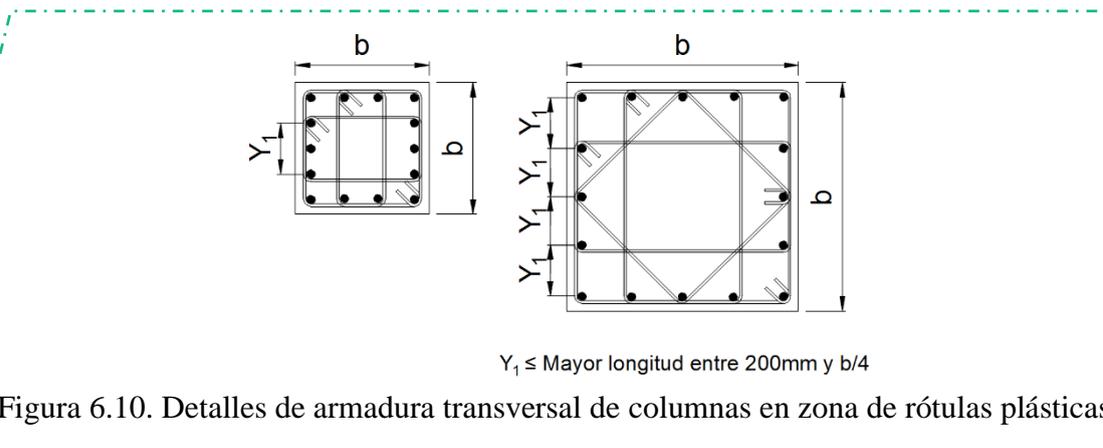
Detalles de armadura transversal de columnas en zona de rótulas plásticas.
